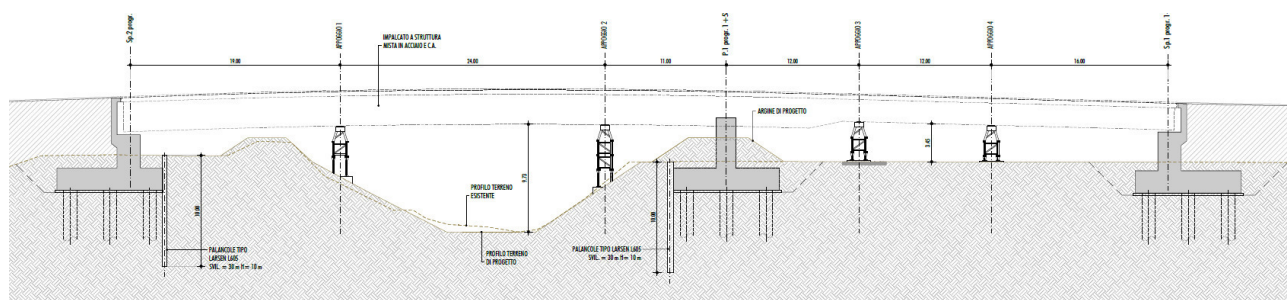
SEZIONE IN ASSE STRADA (VISTA DA MONTE) DURANTE LA FASE DI CANTIERE CON GLI APPOGGI PROVVISORI
